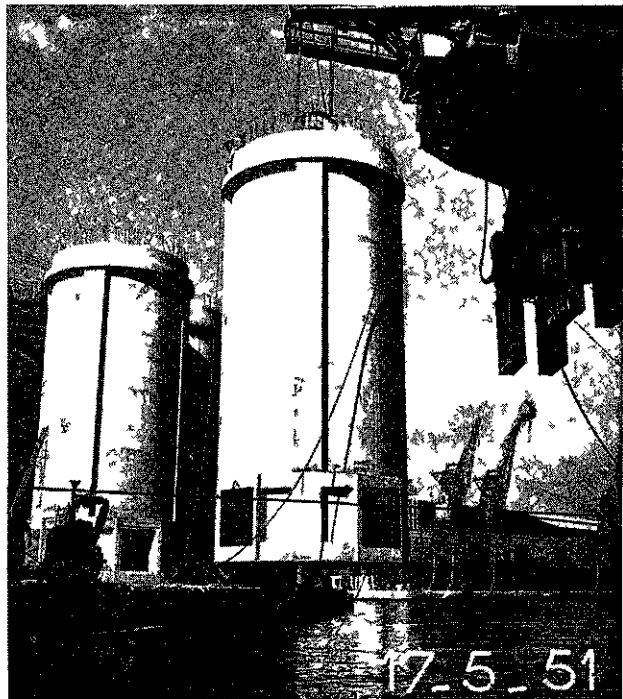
Port de Lavera Chantier de construction des colonnes a Marseille Mise a l'eau d'une colonne par le ponton-mature « SAMSONNE »
